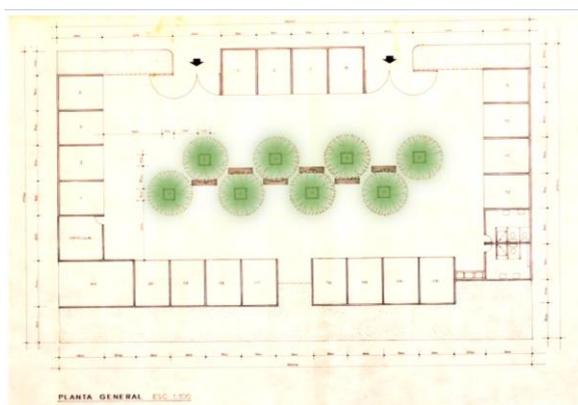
Planta general de arquitectura, centro comercial barrio industrial menor
